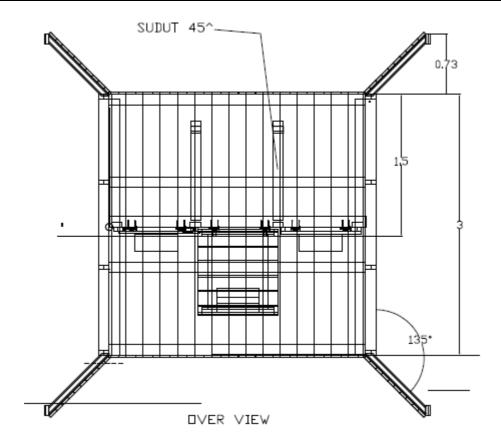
フラップゲート 標準設計図 (平面図)
